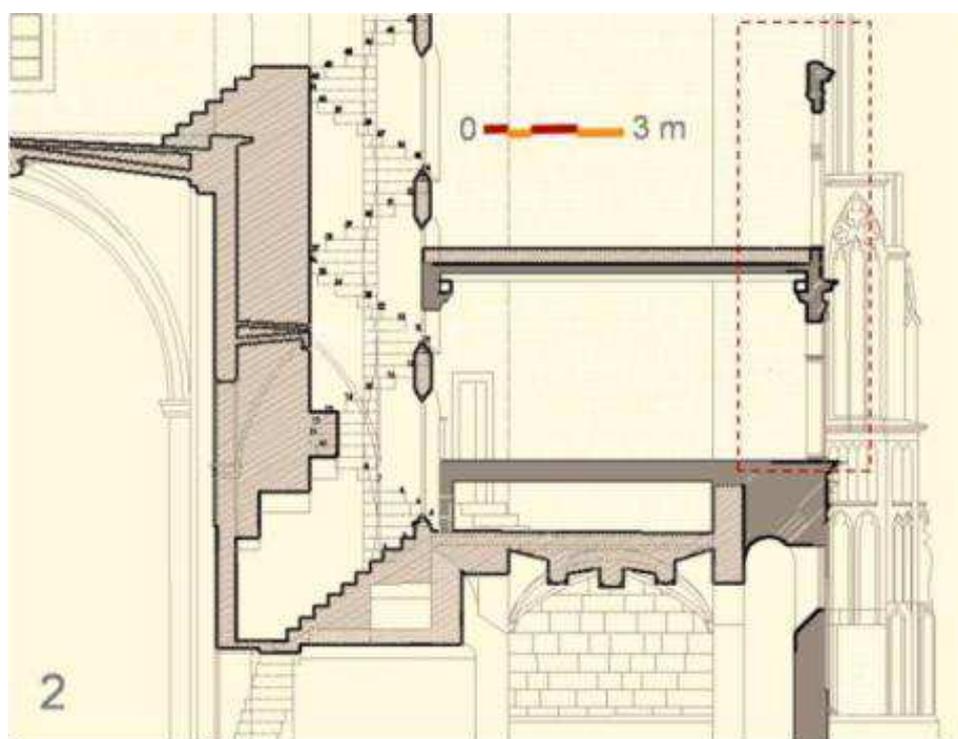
18.5 Hipótesis del autor. Sección de la fachada tras la intervención de Moya en 1974.
